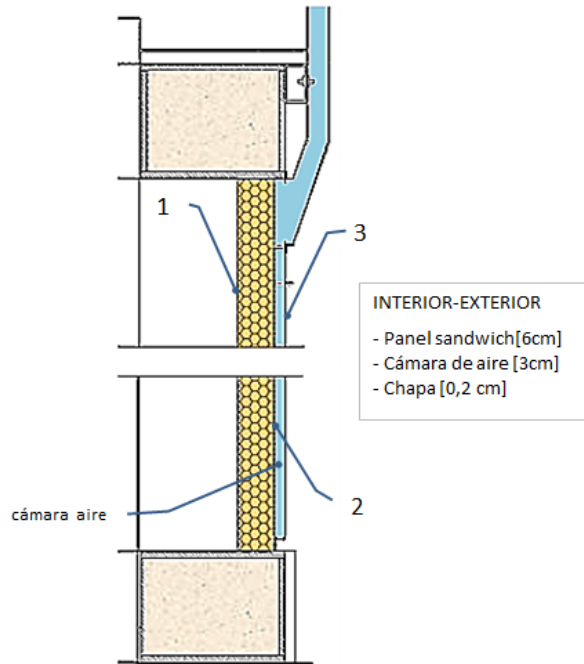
Solución constructiva de la fachada ventilada forzada
